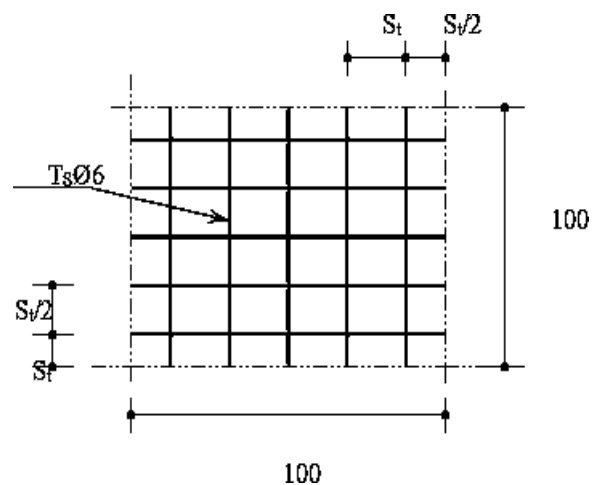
Disposition constructive des armatures de la dalle de compression.
